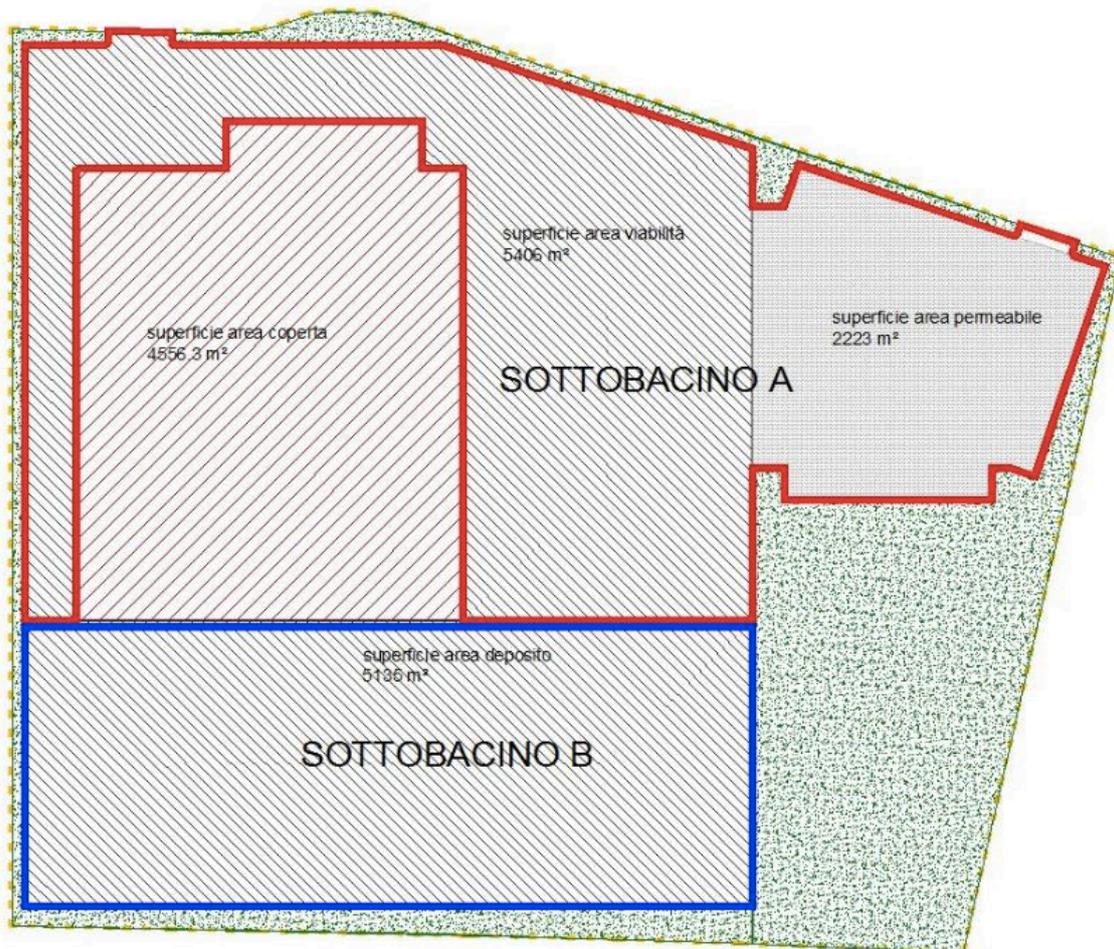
Schema di suddivisione in bacini idraulici delle superfici pavimentate previste dal progetto.
